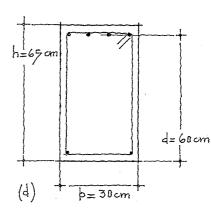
Corte transver\_ sal 4-4, (a).
